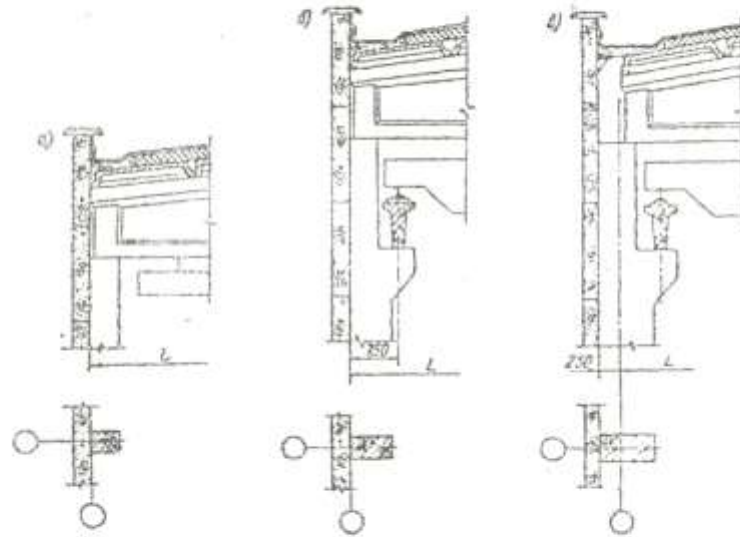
Привязка колонн и стен к продольным: а – в зданиях без мостовых кранов, б – в зданиях с мостовыми кранами (нулевая); в – то же, привязка 250 мм.
